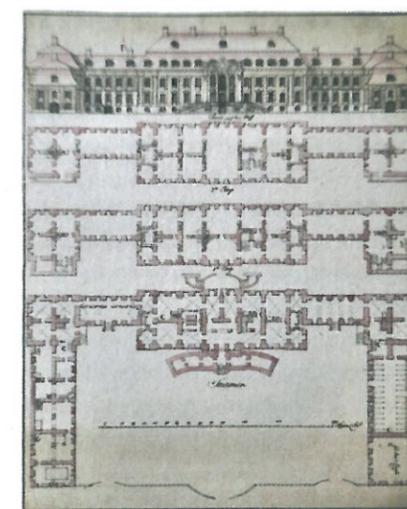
Schwerinsburg, Grundriss und Aufrisse aus dem Planschatz der mecklenburgischen Herzöge.
